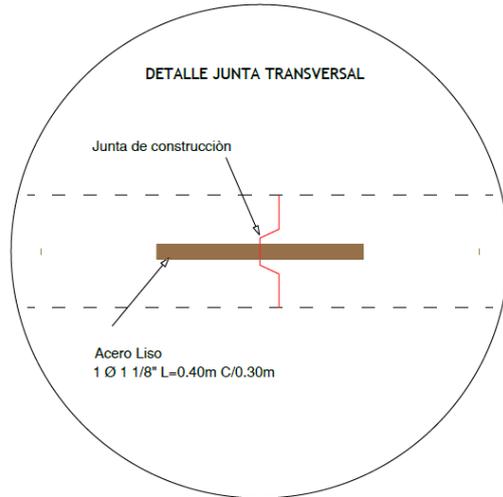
Detalle de la junta transversal. Elaboración Propia
